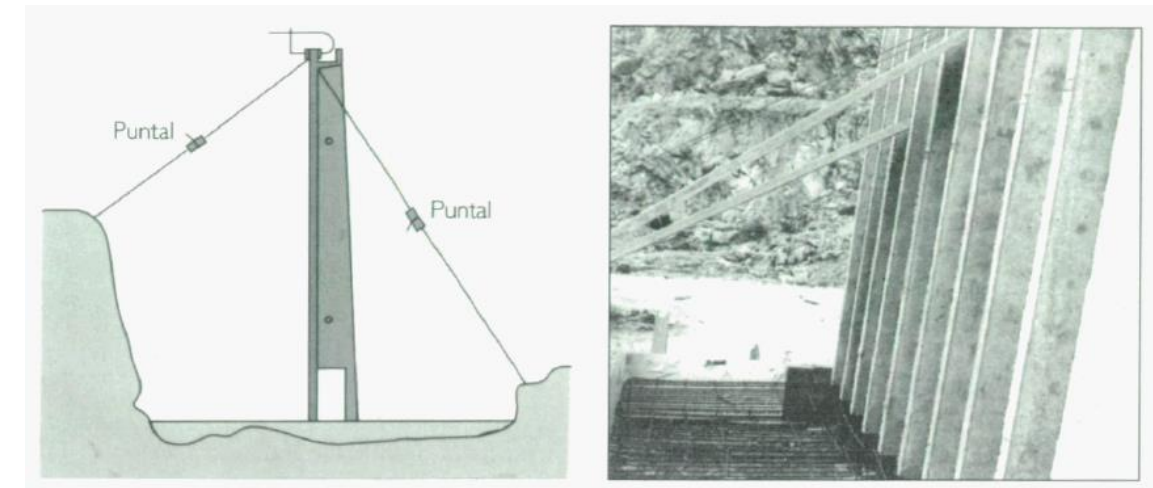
Muro de hormigón prefabricado: esquema e imagen de obra.
